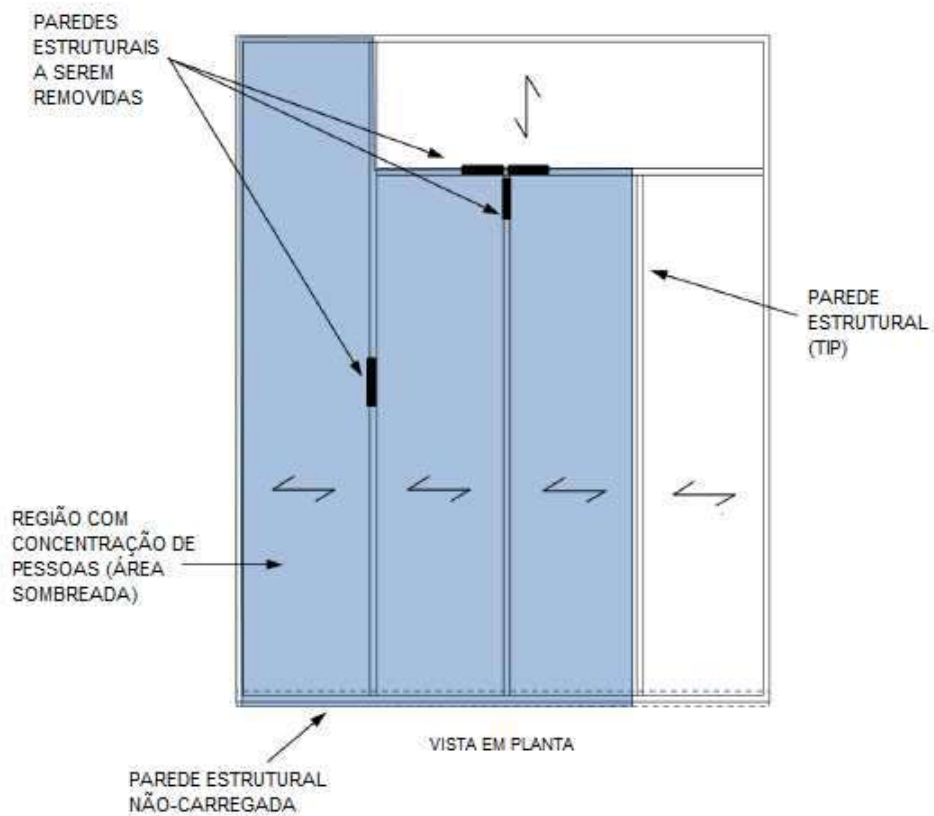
Locais de remoção das paredes estruturais internas (adaptado de GSA, 2013)
